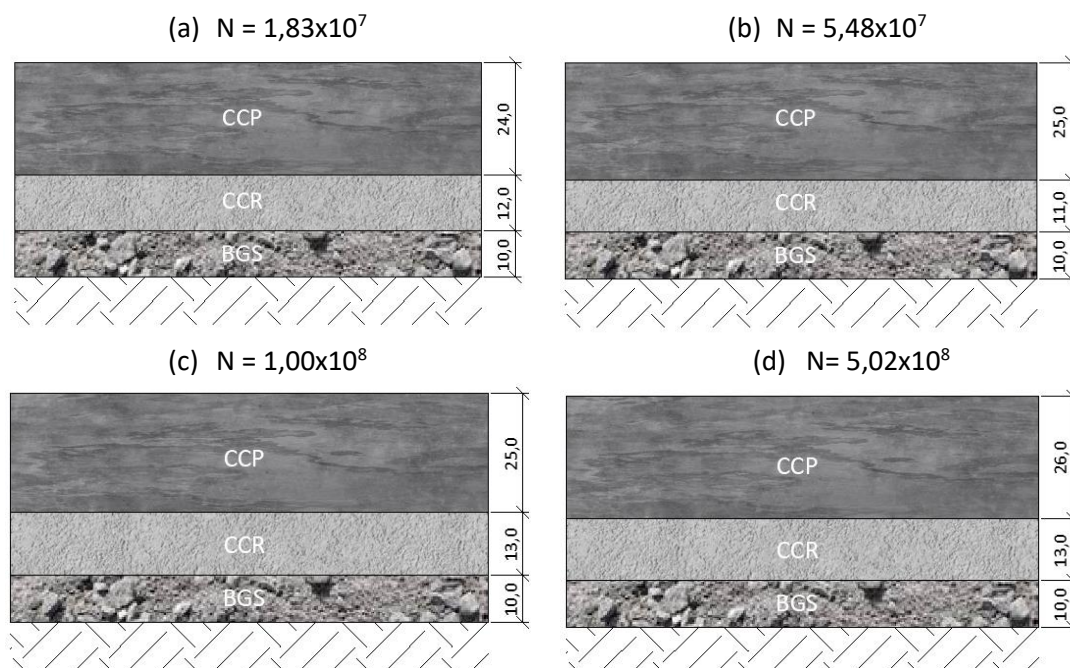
Seções transversais das estruturas em Concreto de Cimento Portland
